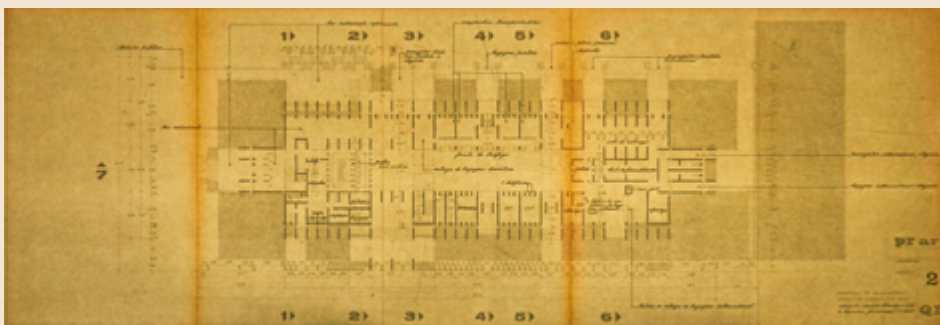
Quelimane air terminal, ground floor plan, circa 1970
